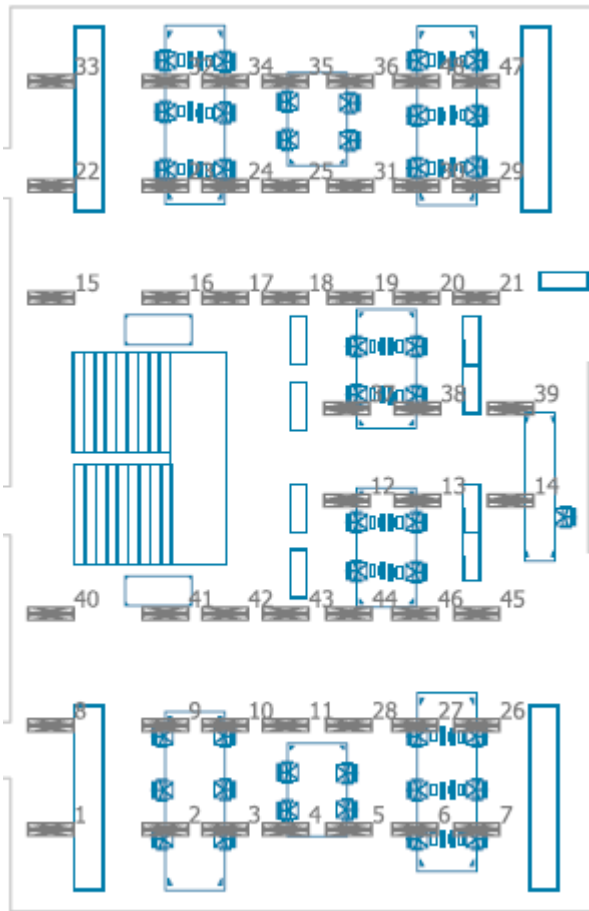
38 Configurazione apparecchi SBS nel locale open-space
